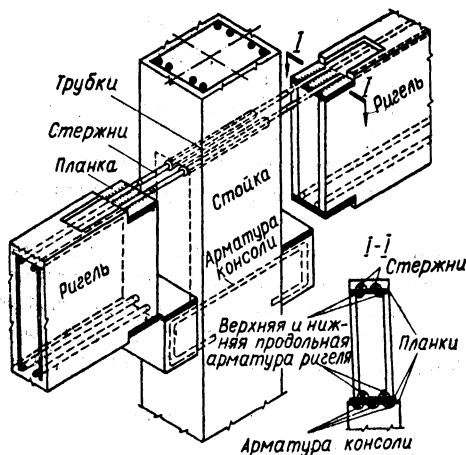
Схема сопряжения ригелей со стойкой при помощи железобетонных консолей и закладных деталей.
